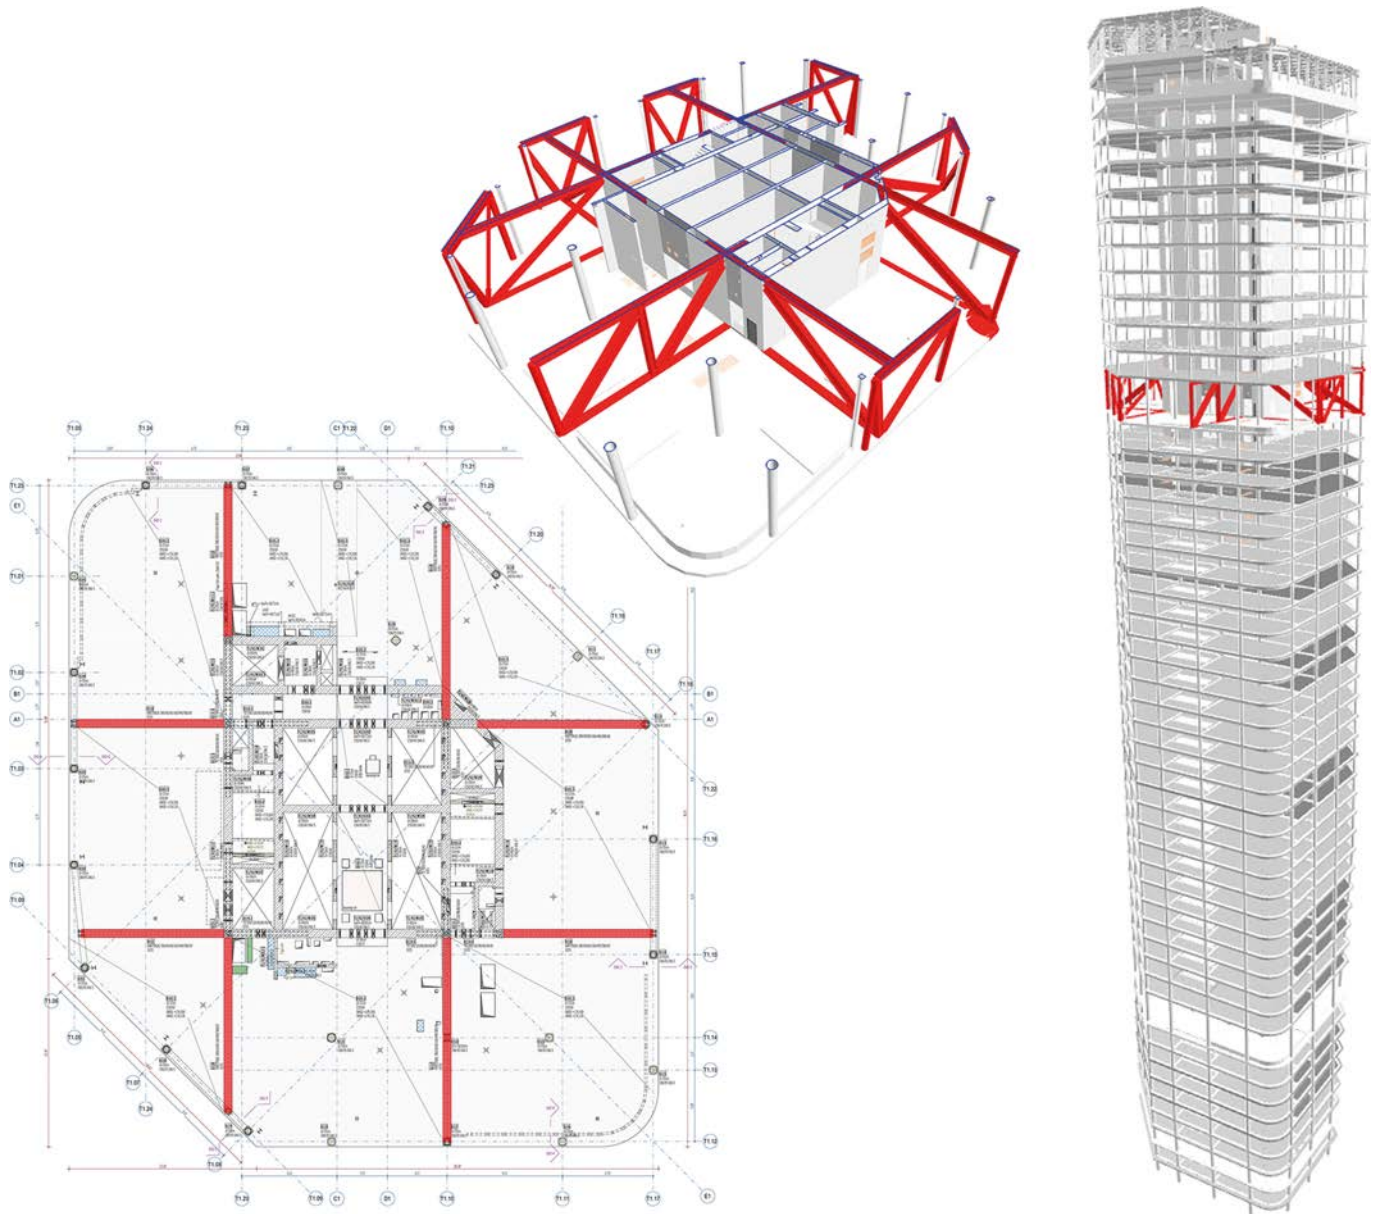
Outrigger T1 in Grundriss und Isometrie (Quelle: ATW FOUR)
